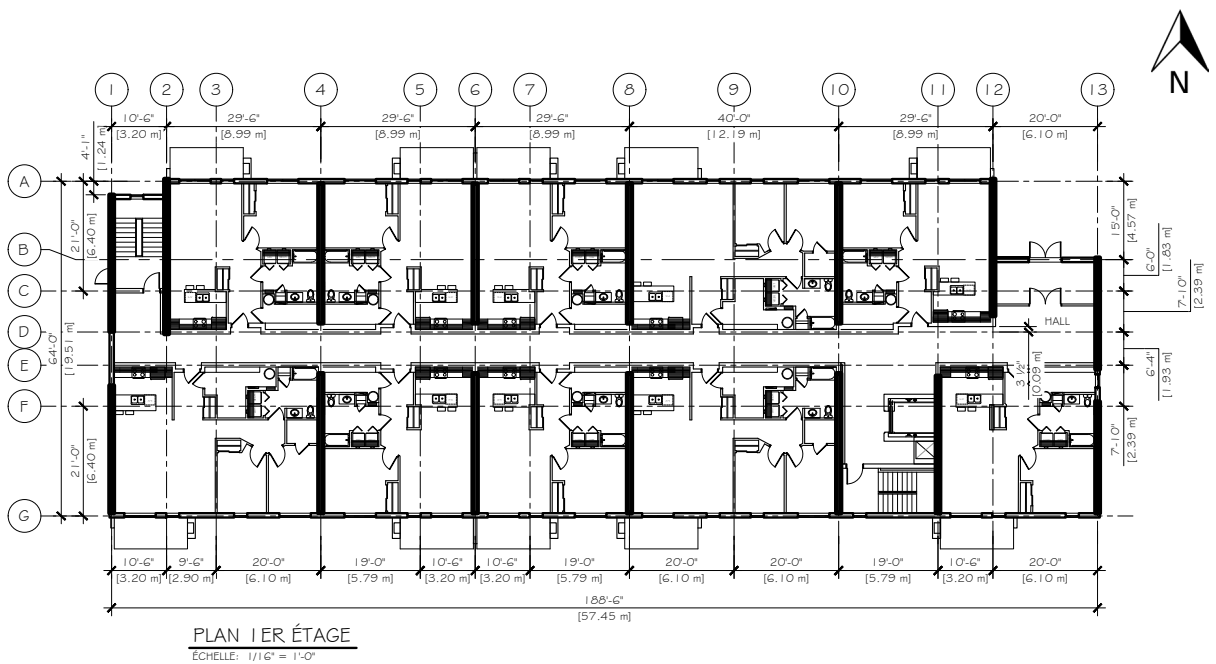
• Vue en plan du 1<sup>er</sup> étage
